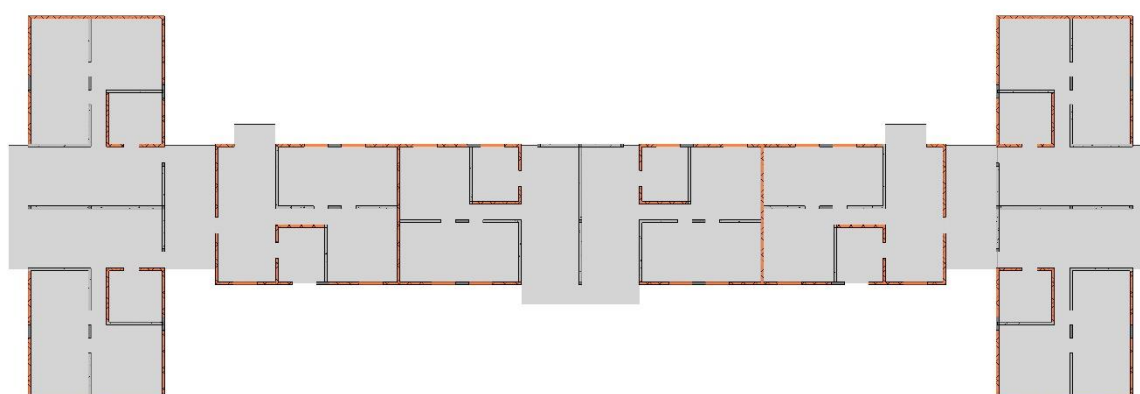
Pianta architettonica dei piani primo e secondo
